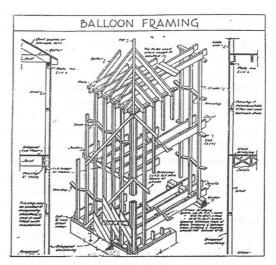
Sistema americano Balloon-frame (Araujo y Seco 1986)
